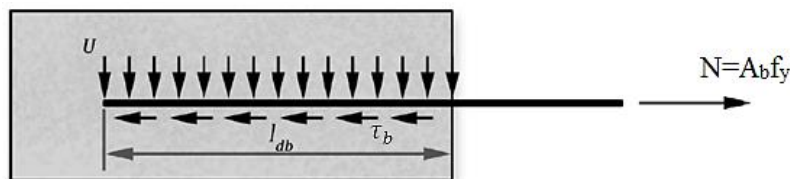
Comprimento de aderência - Caneiro (2010).
